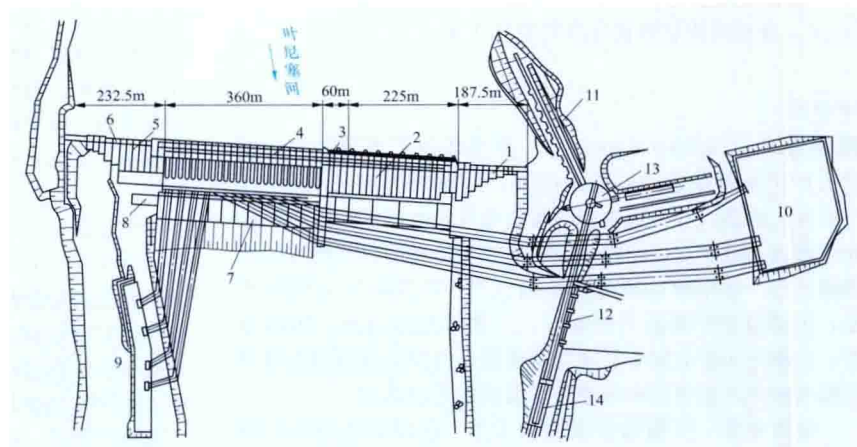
克拉斯诺雅尔斯克水电站枢纽平面布置图
